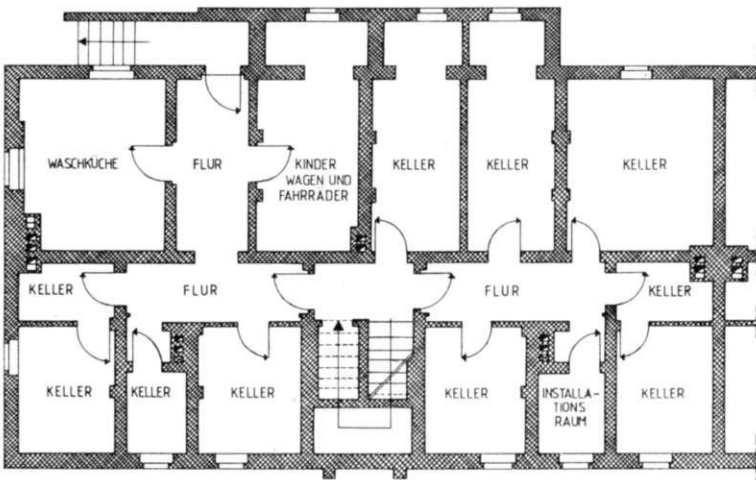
Grundrisse der Wohnbebauung in der Brunnerstraße
